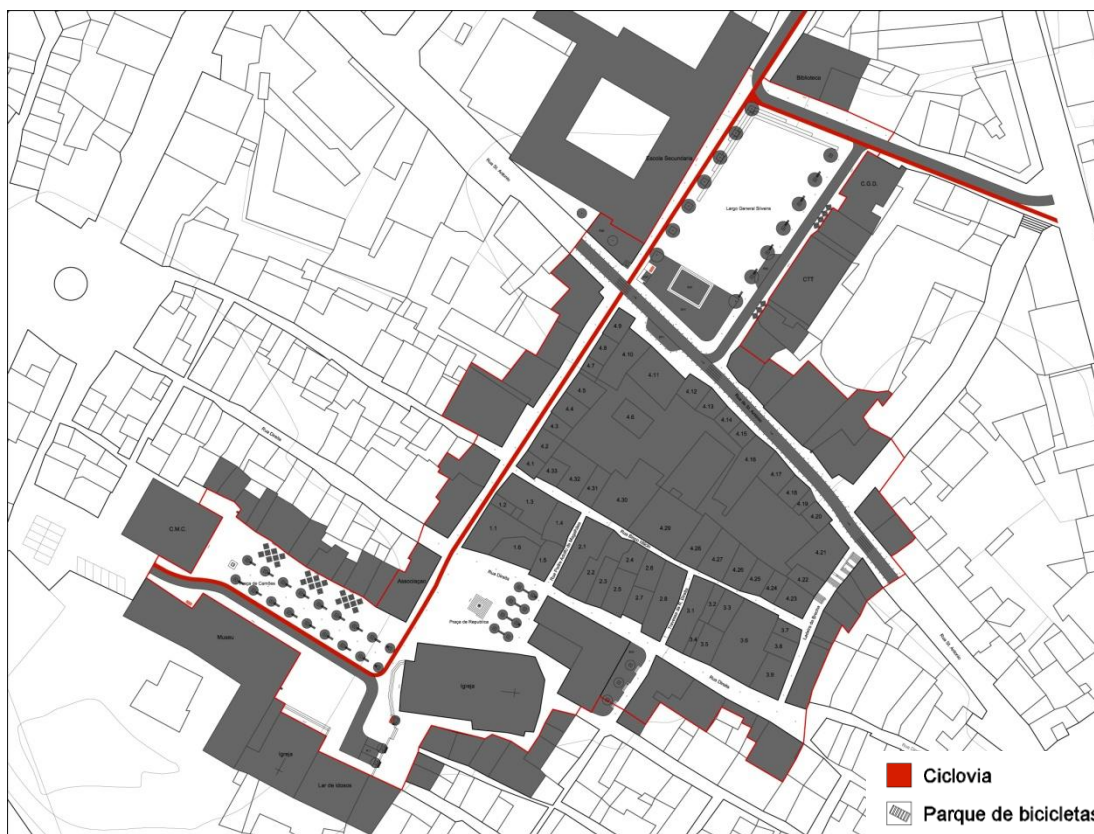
Planta de proposta de ciclovia (anexo b.06)
